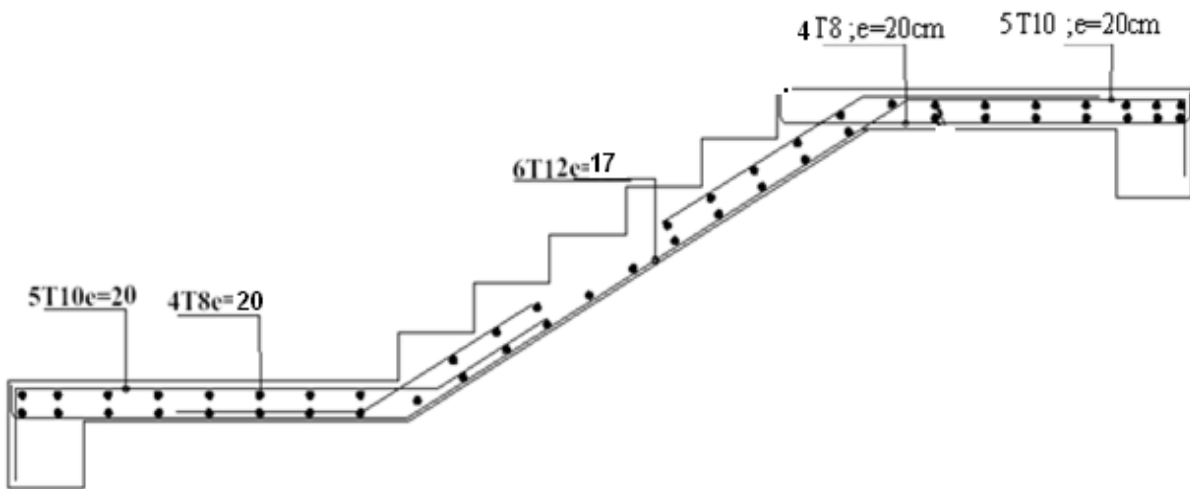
schémas de ferrailage de l'escalier volee 1
